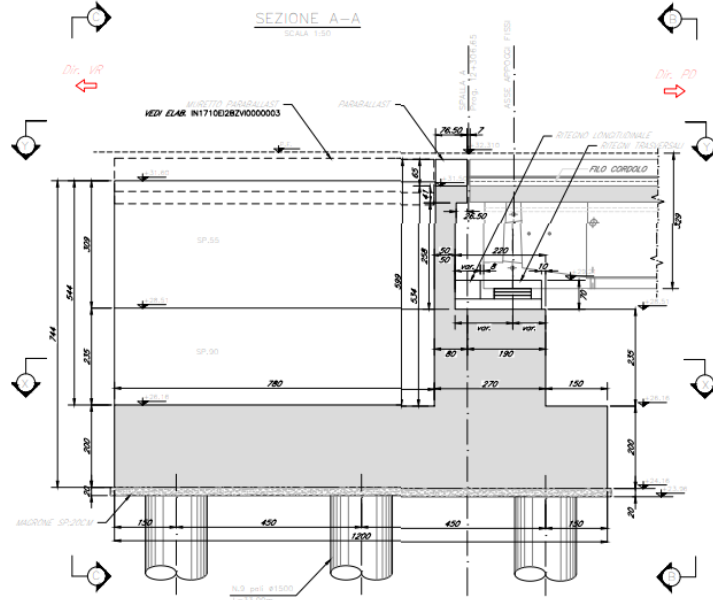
Sezione longitudinale Spalla A
